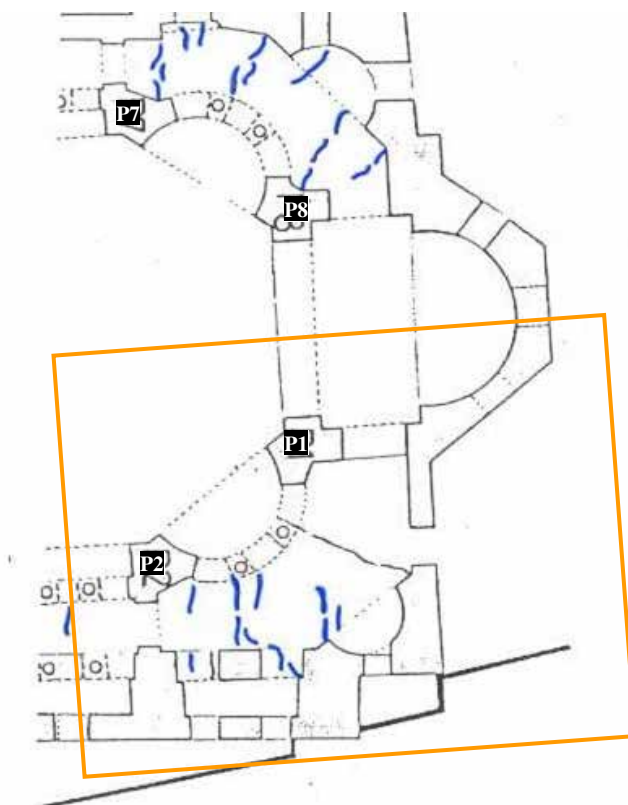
Localización en planta de grietas en la planta baja de la mezquita. El recuadro naranja indica la ¼ parte modelada, vid. Capítulo 6 (Arun, 2002)
